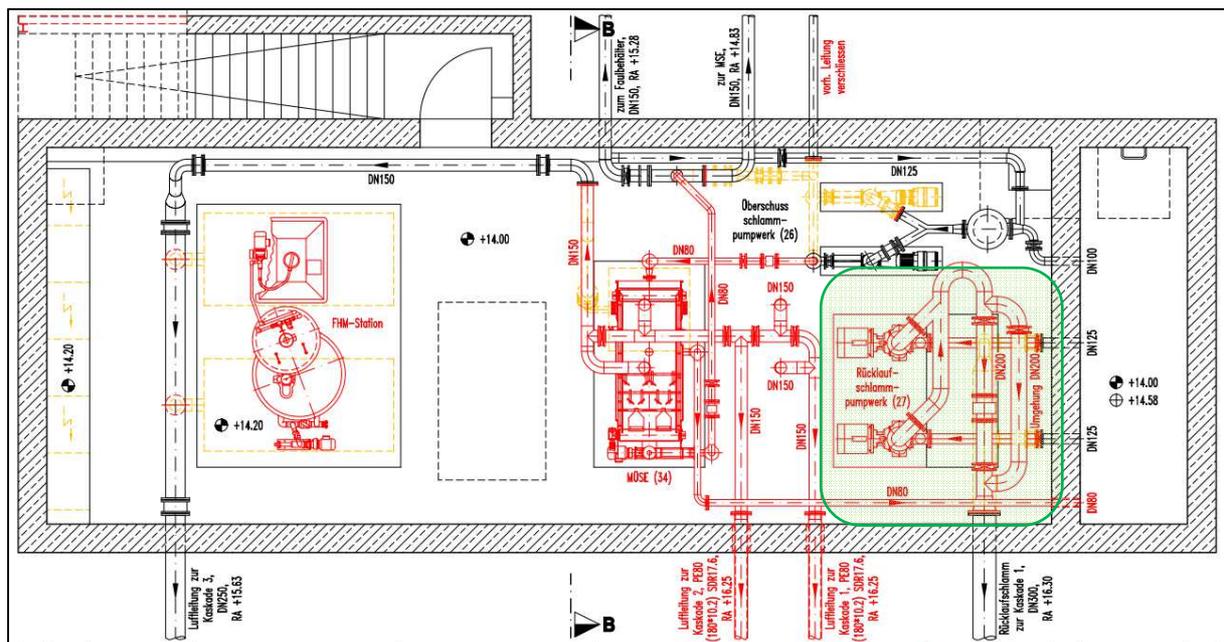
Lage des Rücklaufschlammumpwerks im Maschinenkeller
